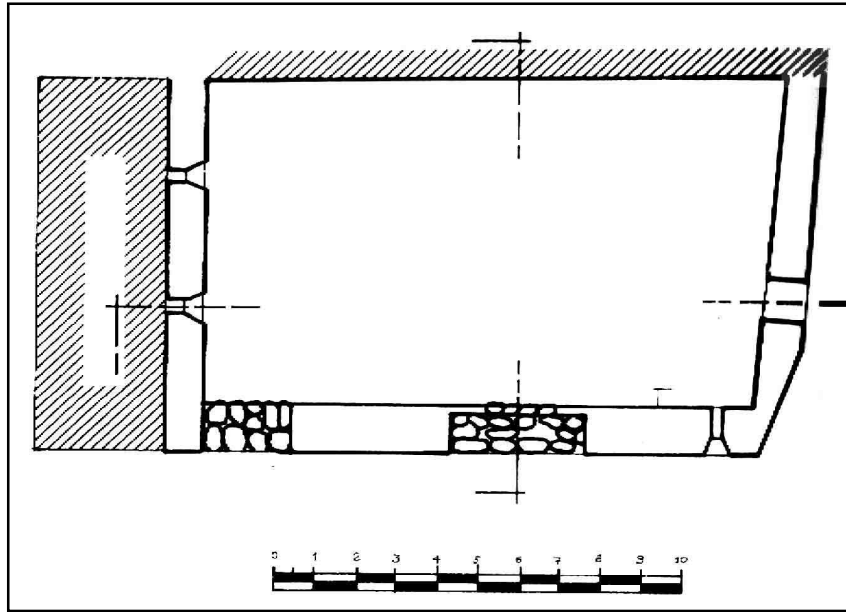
مسجد اليعقوبي - واجهة وقطاع ومسقط أفقي.
